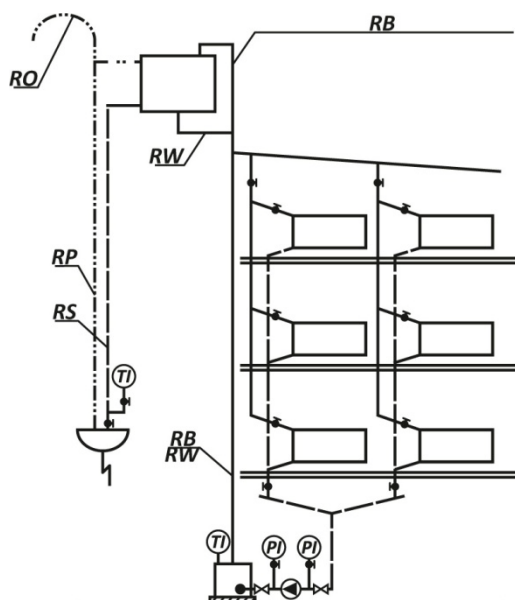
Schemă de principiu pentru un sistem de încălzire cu apă caldă echipat cu un cazan sau schimbător de căldură, cu distribuție superioară, cu pompa montată pe retur.
